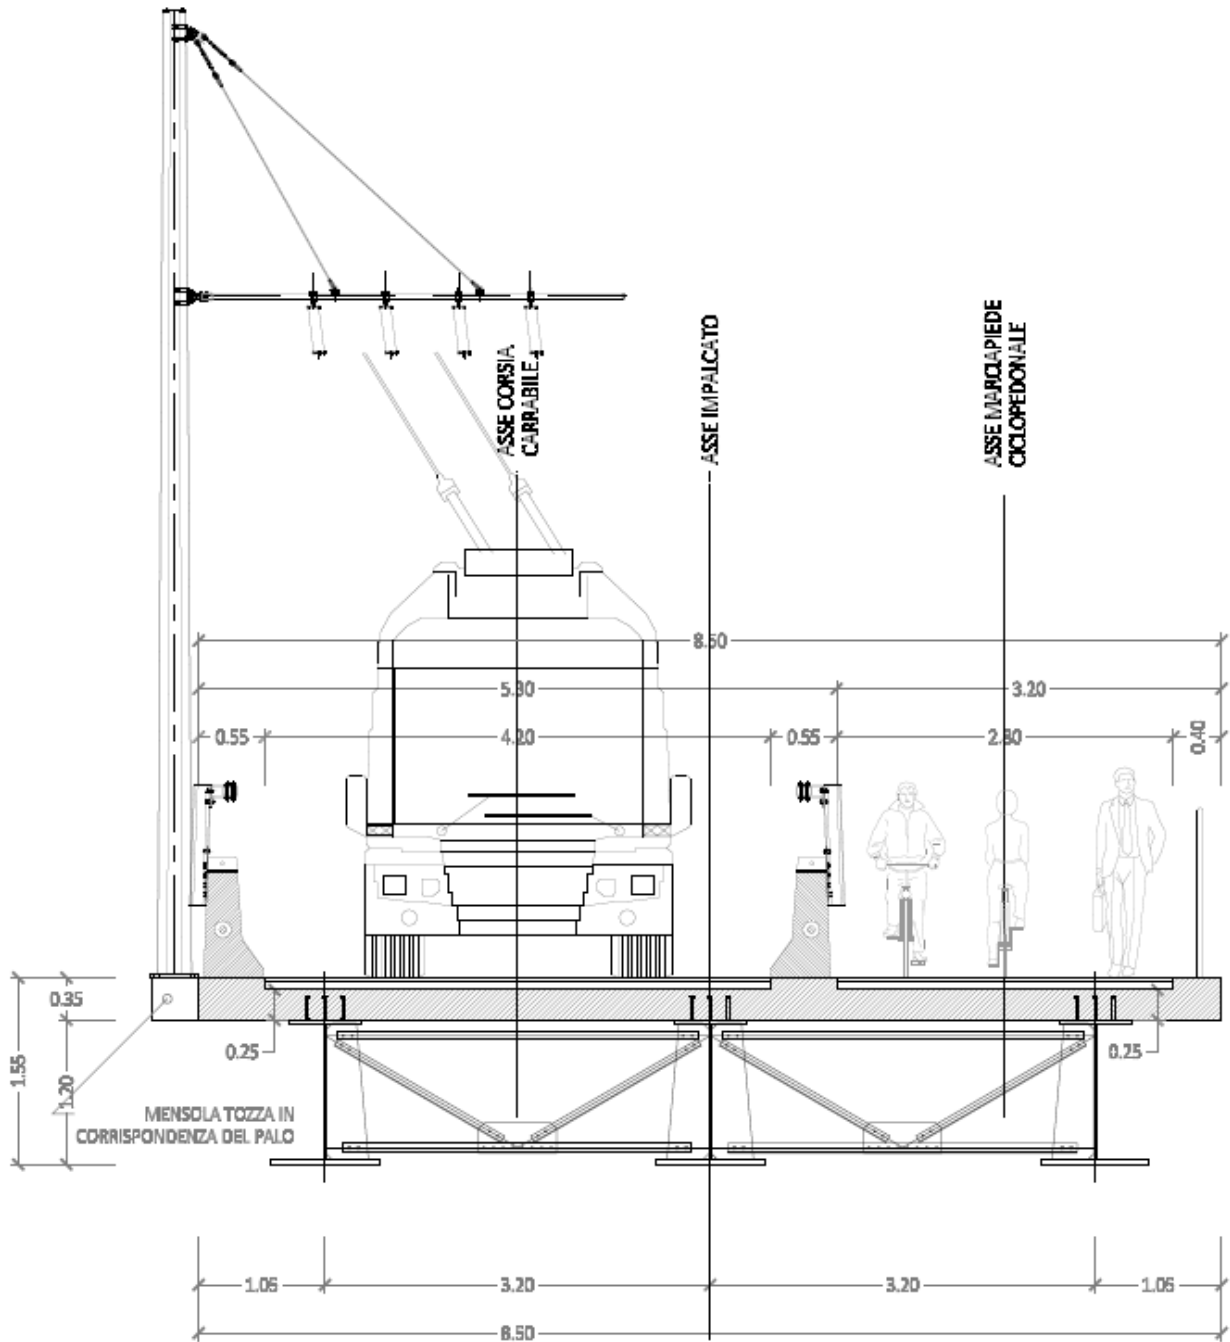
Sezione tipo sul nuovo ponte sul Deviatore Marecchia in corrispondenza campate e appoggi su spalle
